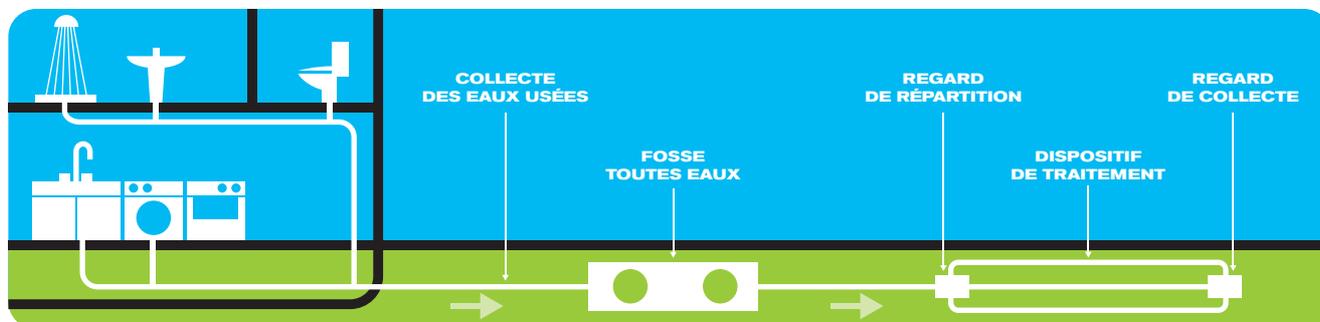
Schéma d'un dispositif d'assainissement autonome
